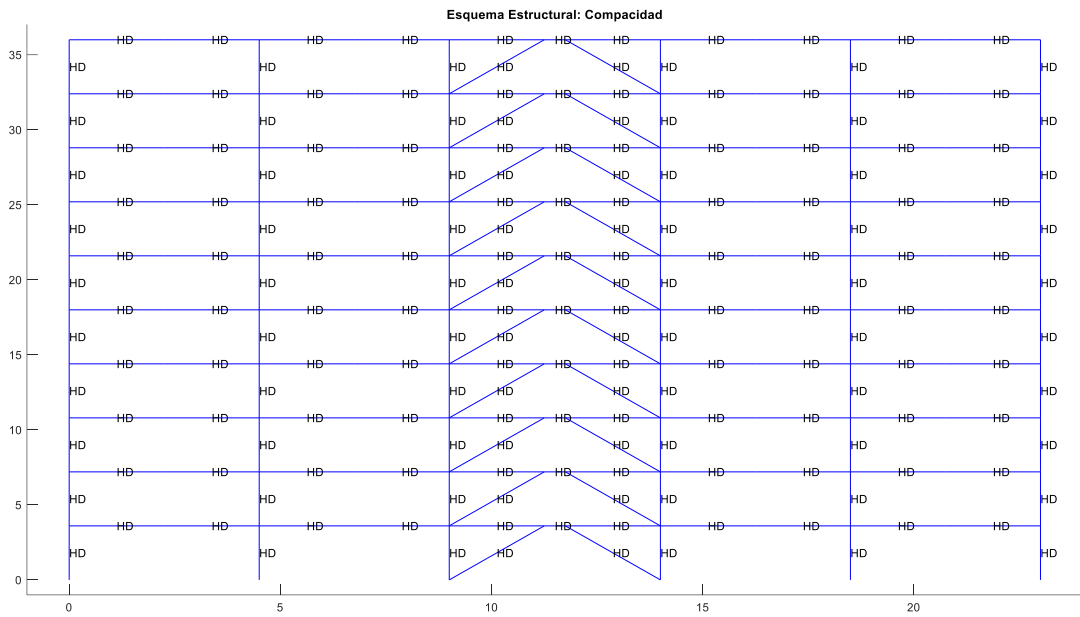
Compacidad de secciones del pórtico, estructura EBF, Ejes 1, 3.
